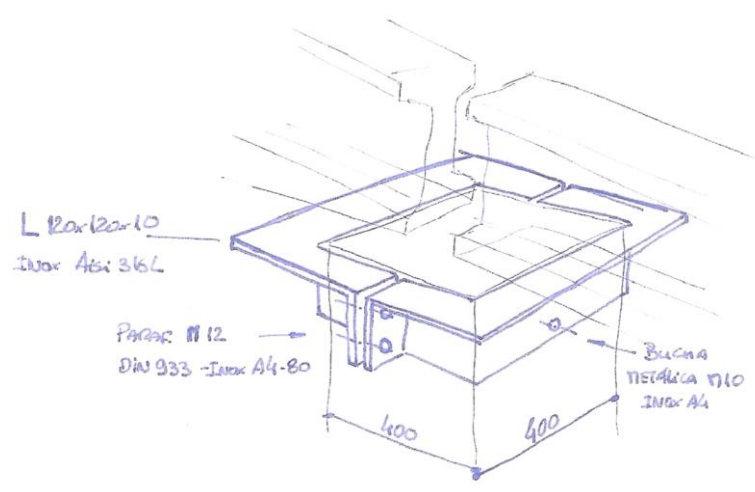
Desenho da braçadeira a colocar nos pilares [15]
